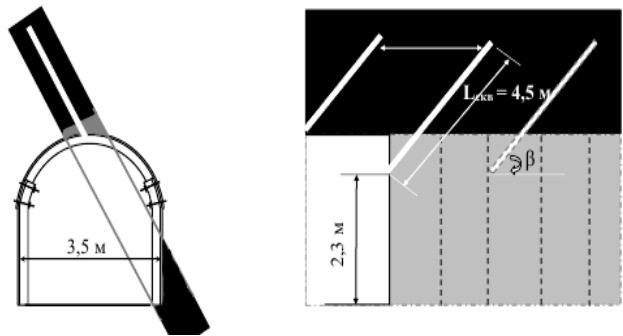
Технологическая схема расположения нагнетательных скважин при закреплении нависающего угольного массива в вентиляционном штреке или надштрекового целика при разработке крутых пластов
